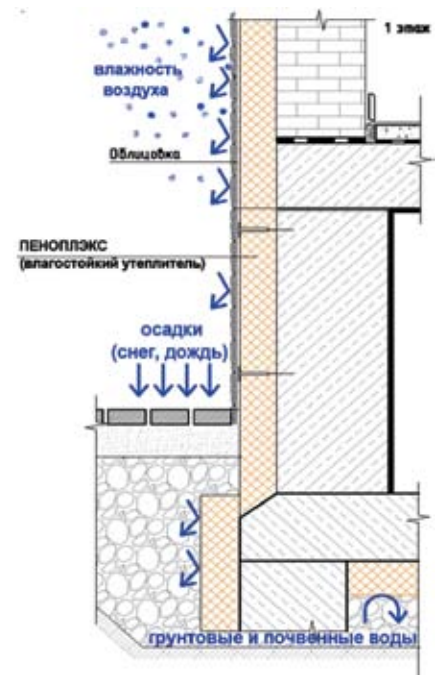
Схема теплоизоляции цокольного и первого этажа с применением плит ПЕНОПЛЭКС®
